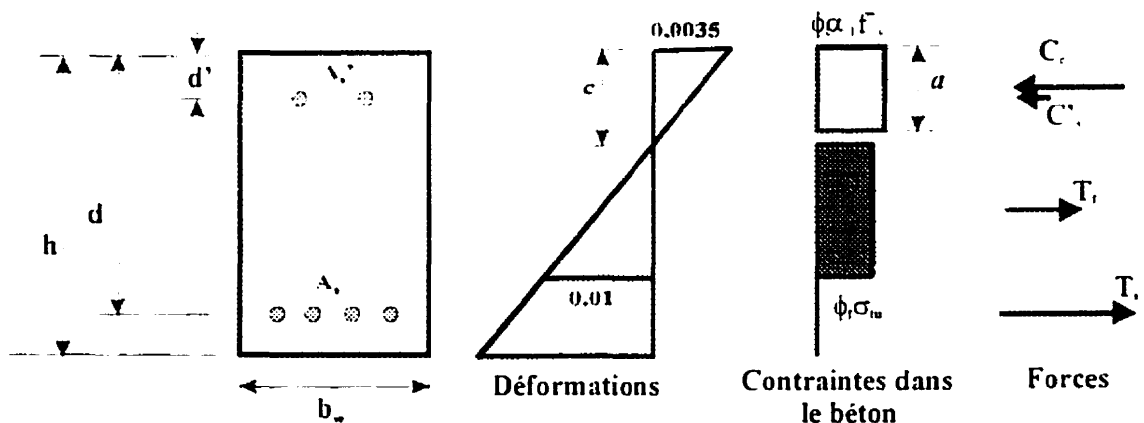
Schéma des contraintes et déformations d'une section de poutre en béton armé avec fibres d'acier
